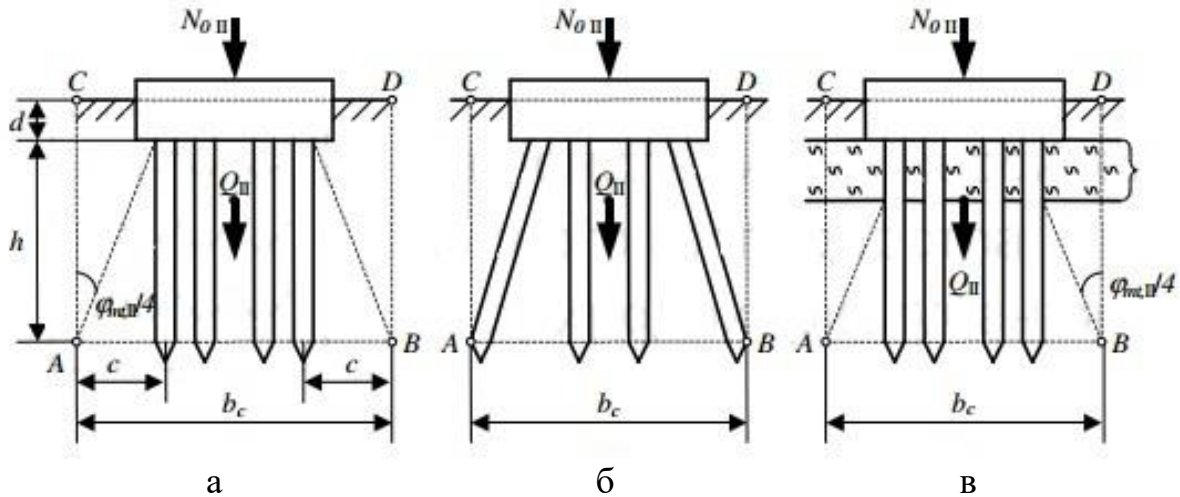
Схема для визначення меж умовного фундаменту при розрахунку осадки пальових фундаментів: а – при вертикальних палях; б – при похилих палях; в – при верхньому дуже слабкому шарі
